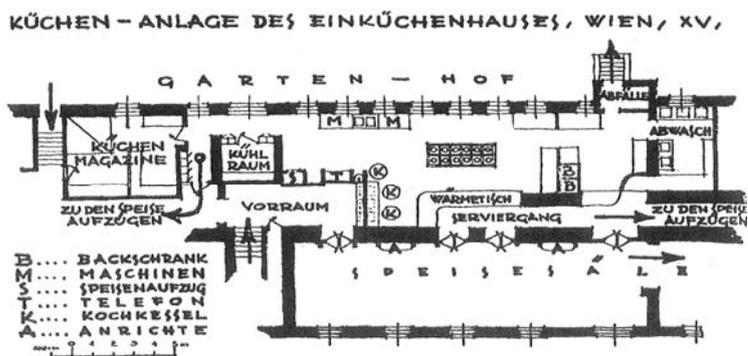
Grundriss des Einküchenhauses, Wien
